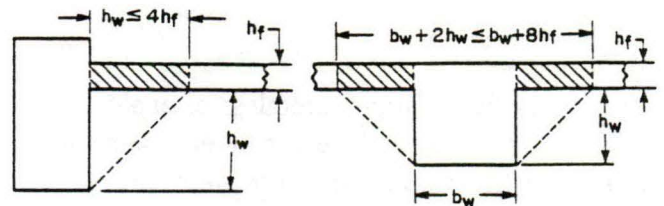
Ejemplos de la porción de losa que debe incluirse con la viga, según la sección 13.2.4.
